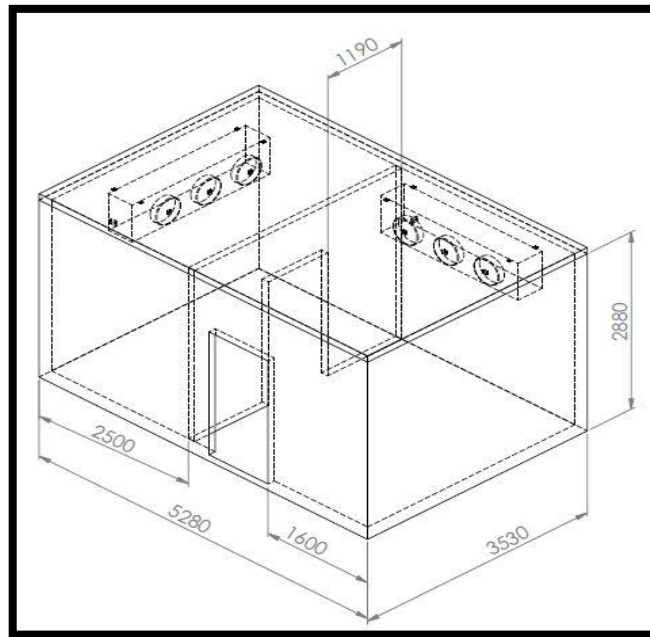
Vista isométrica del redimensionamiento de la cámara de la planta piloto.
